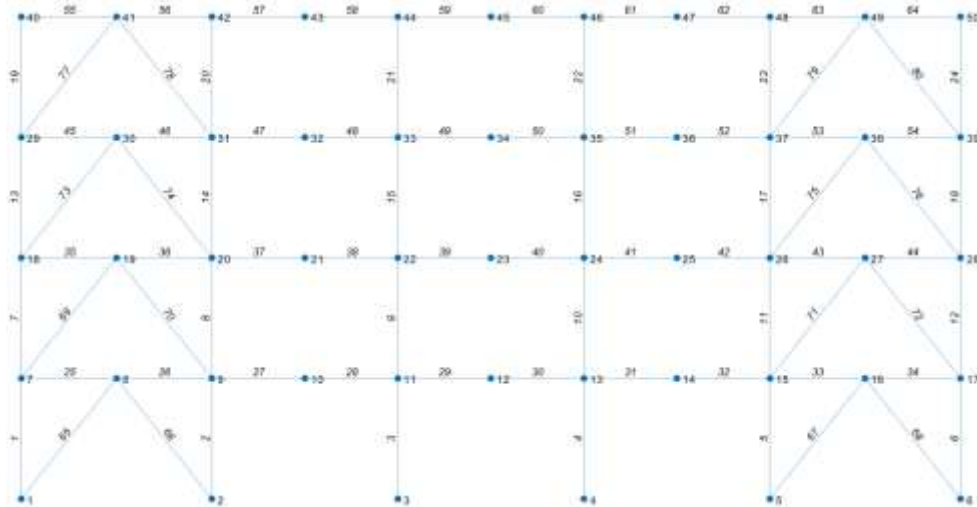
Numeración de nudos, elementos de columnas, vigas y diagonales.
